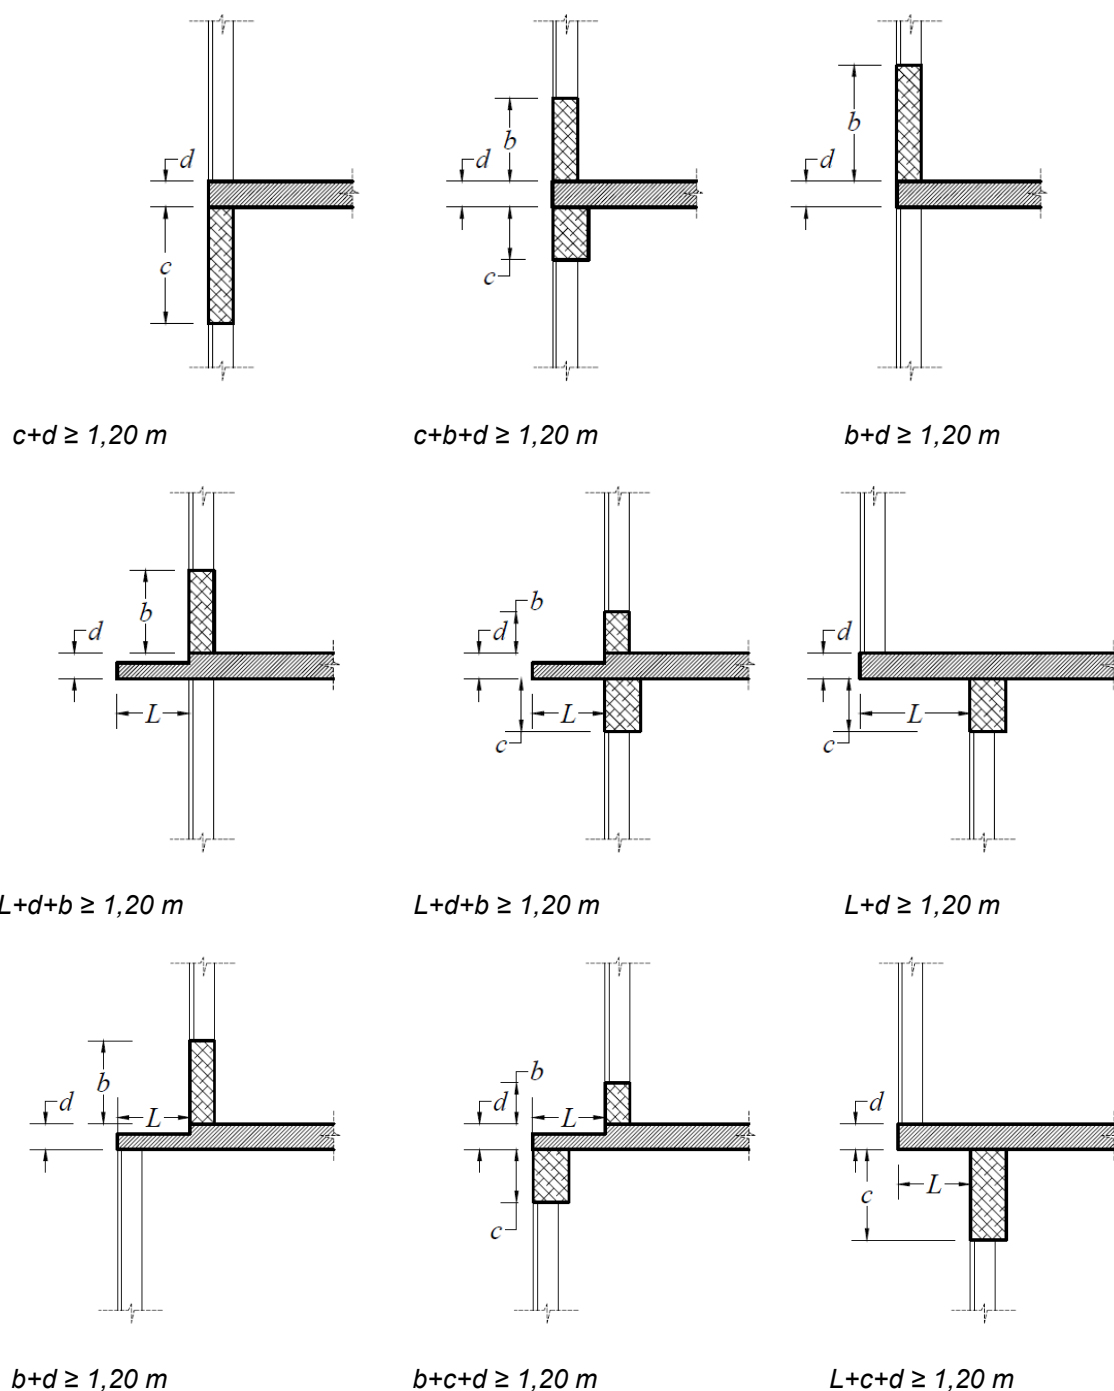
Calcul soluții constructive cu H + L (exemplu varianta normată de 1,20 m)
